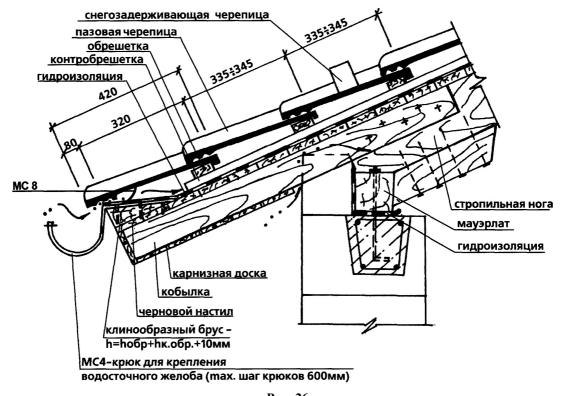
Устройство карнизного свеса с гидроизоляцией из рубероида для схемы II
